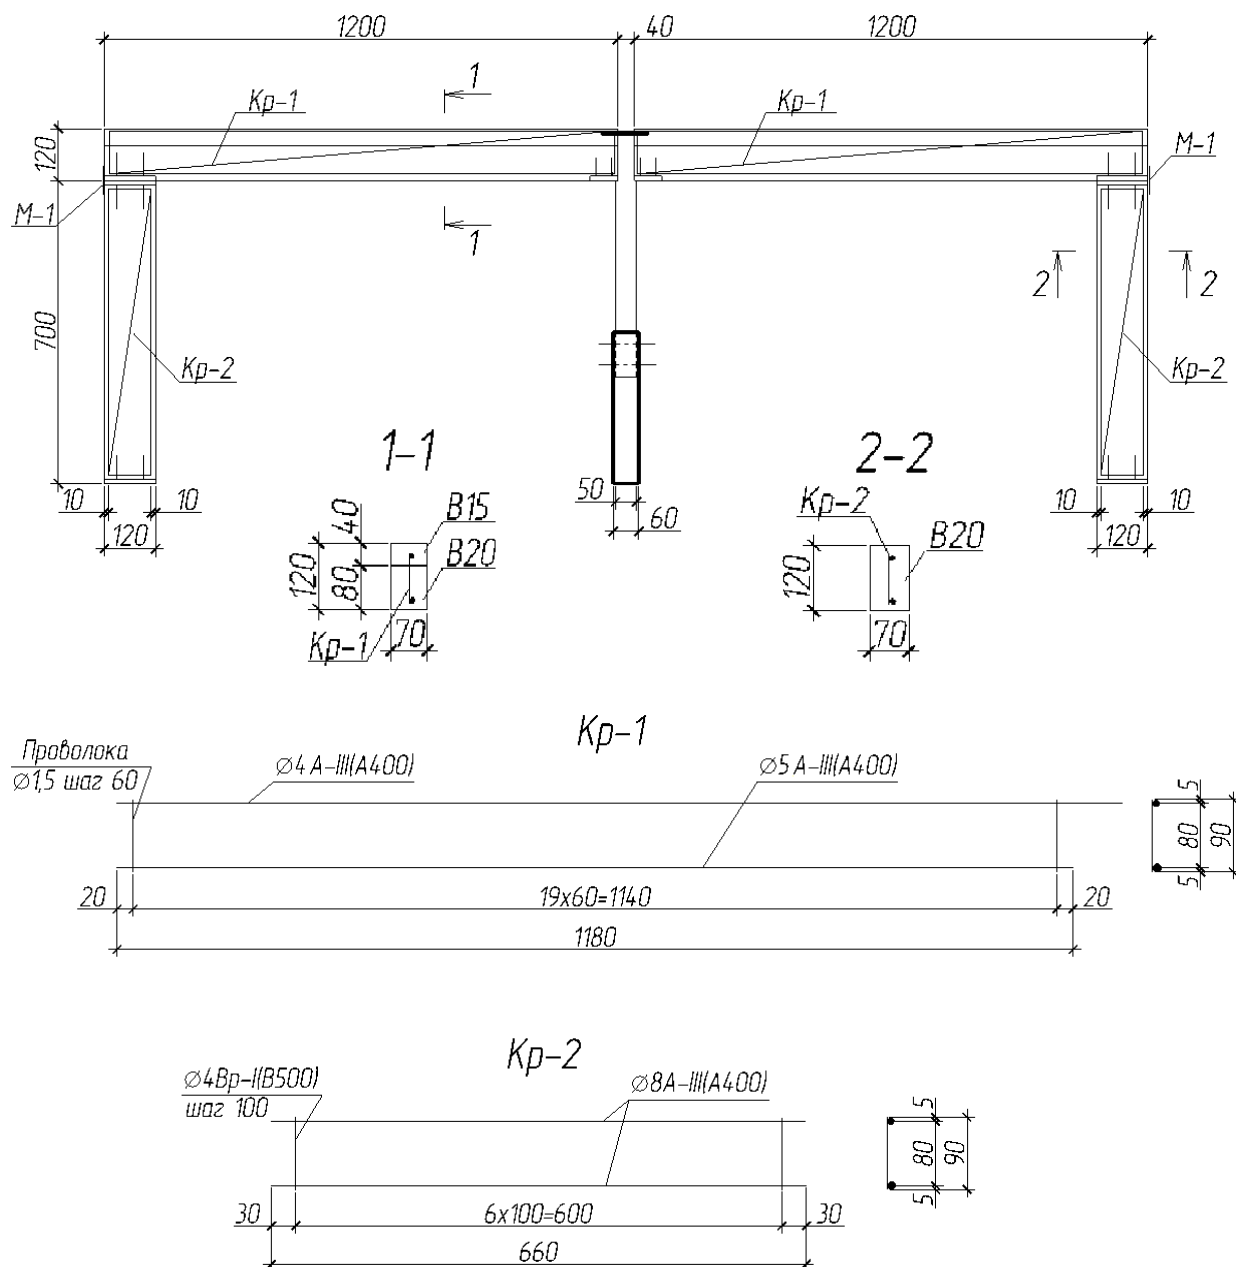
Схема армирования фрагмента железобетонной пространственной рамы
